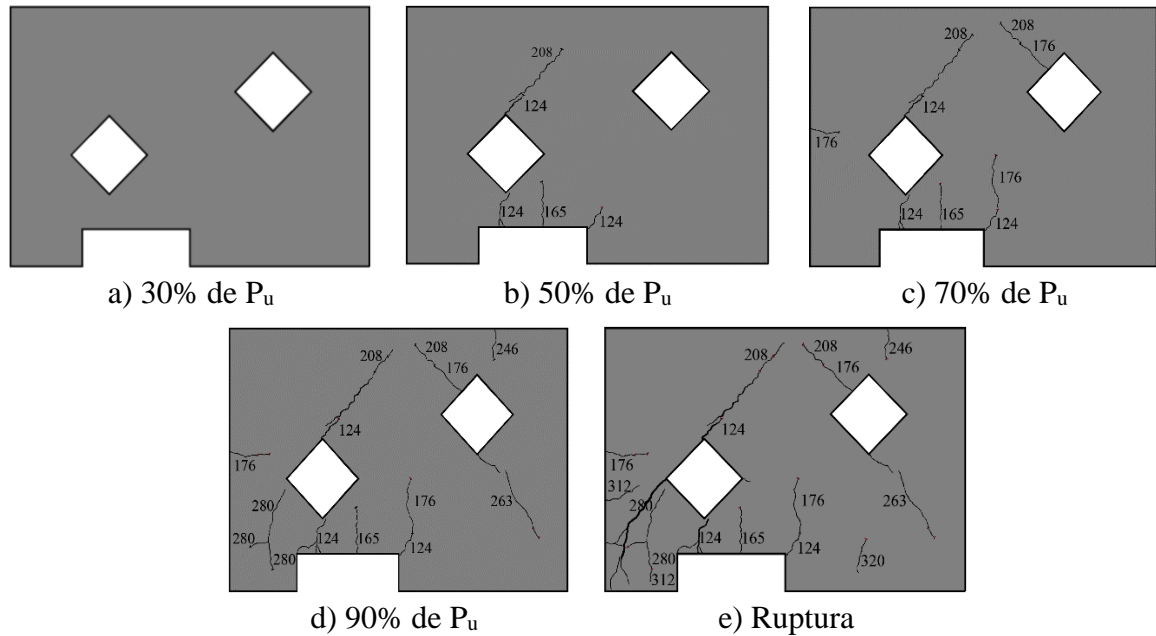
Mapa de fissuração DB2-W-H2-U-A-1 (força indicada em kN)
